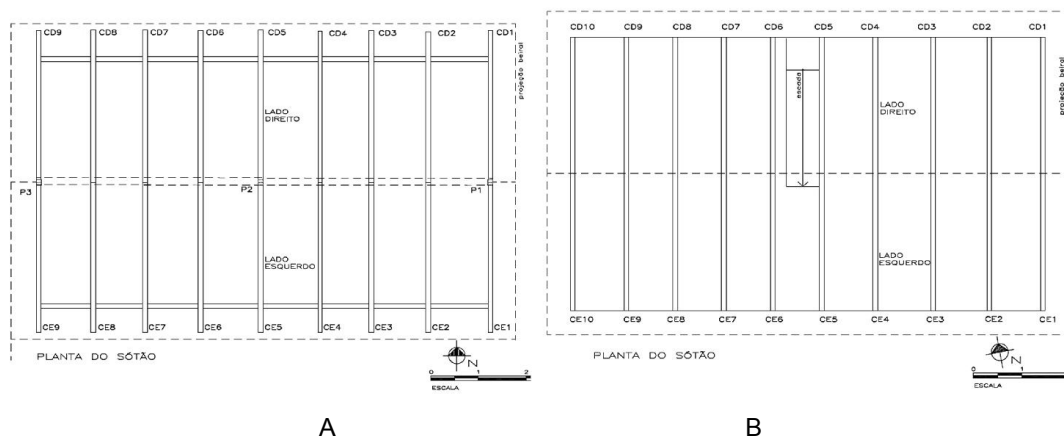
PLANTA DO SÓTÃO DA CASA GROCHOCKI (A), PLANTA DO SÓTÃO DA CASA CETNARSKI (B).
